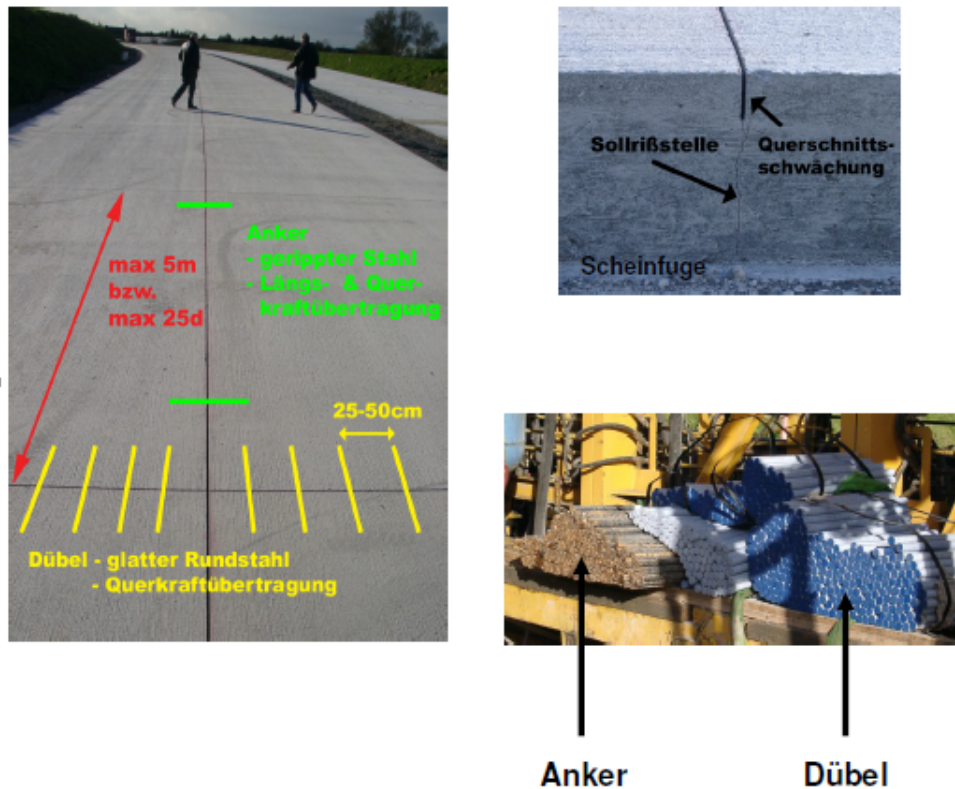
Betondecke; Bild entnommen aus [1]
